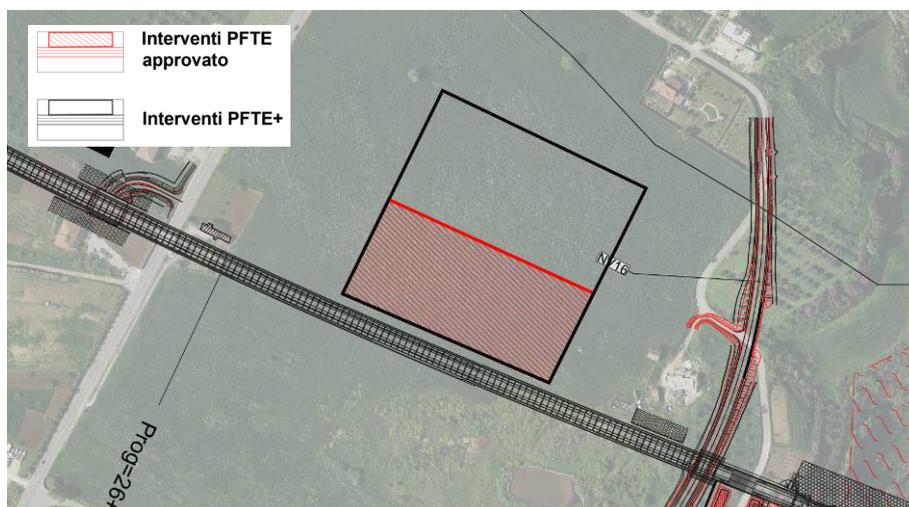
Modifiche all'area di cantiere AS.08. Sovrapposto cantieri con il sistema dei vincoli (in rosso il PFTE e in nero il PFTE+)
